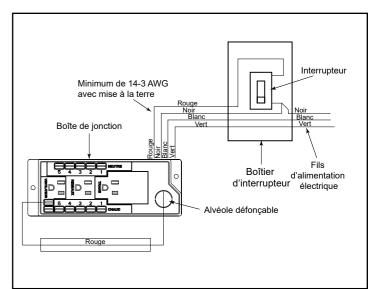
Boîte de jonction câblée à l'interrupteur mural ou BC10
